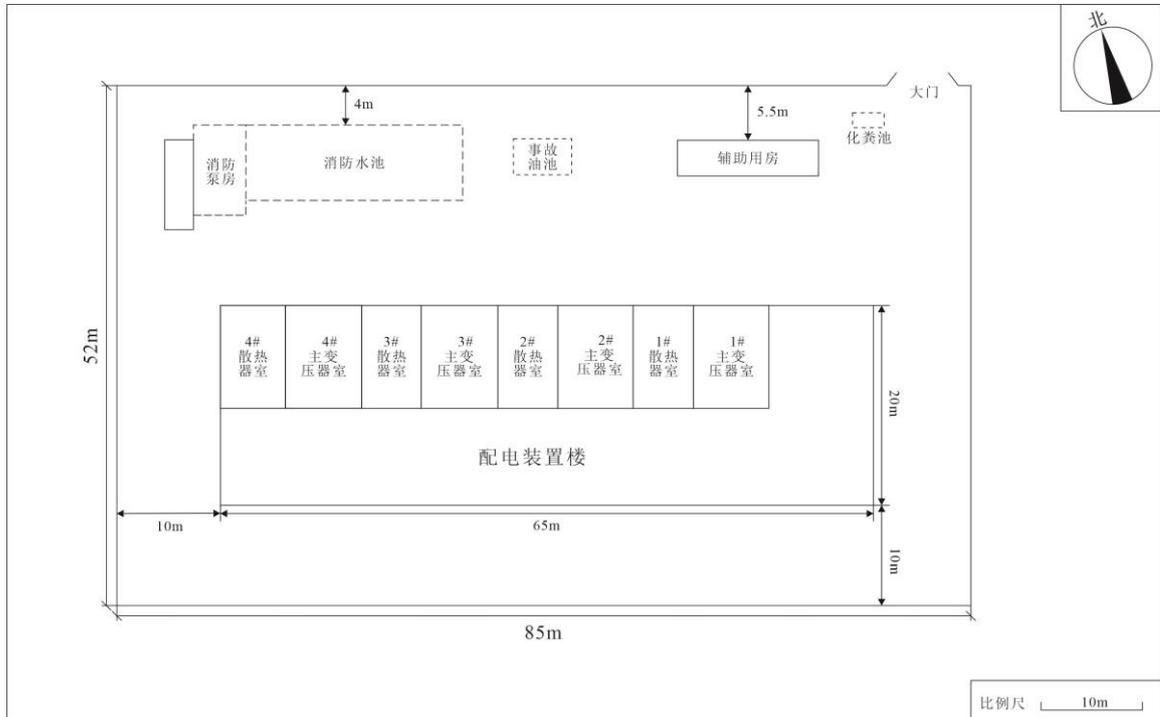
拟建西安集结中心110kV变电站总平面布置示意图
